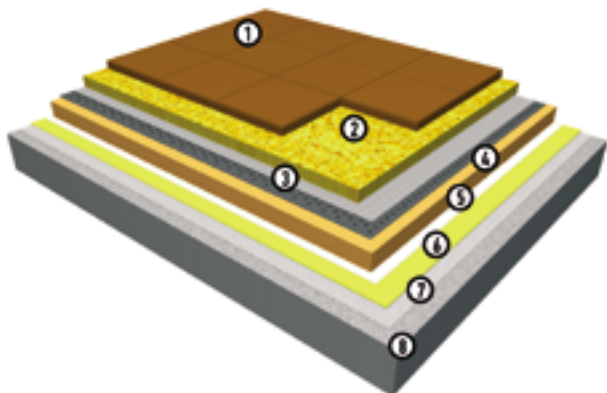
Устройство эксплуатируемого покрытия: 1 – балластный слой; 2 – песчаная подушка; 3 – дренажный слой; 4 – теплоизоляция ПЕНОПЛЭКС®; 5 – геотекстиль; 6 – PLASTFOIL® Geo; 7 – геотекстиль плотностью 300 г/м²; 8 – железобетонное основание
